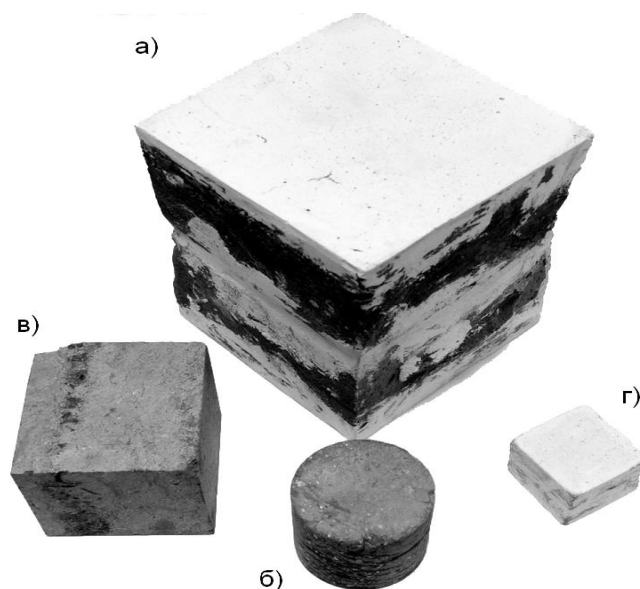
Образцы для испытания материалов каменных конструкций:
